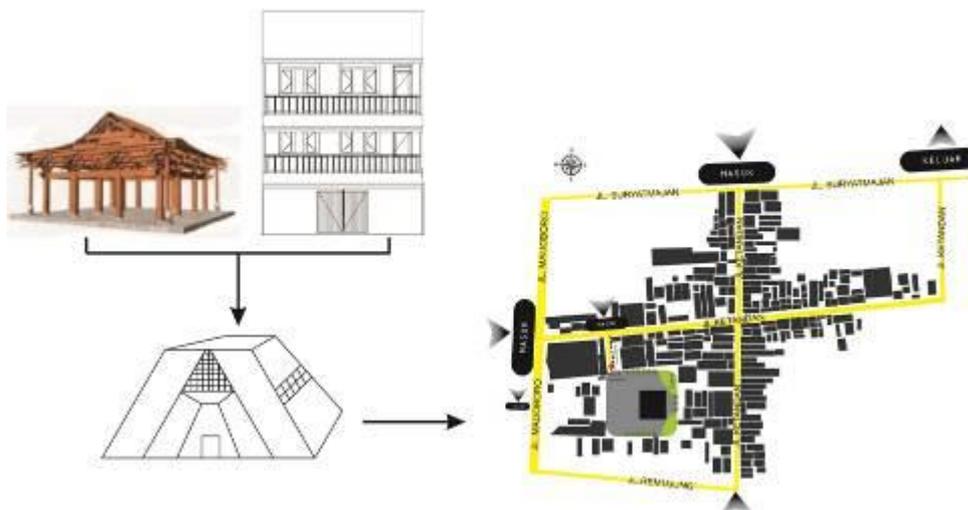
Sketsa Konsep Penampilan Massa Bangunan Baru di Pecinan Ketandan.
